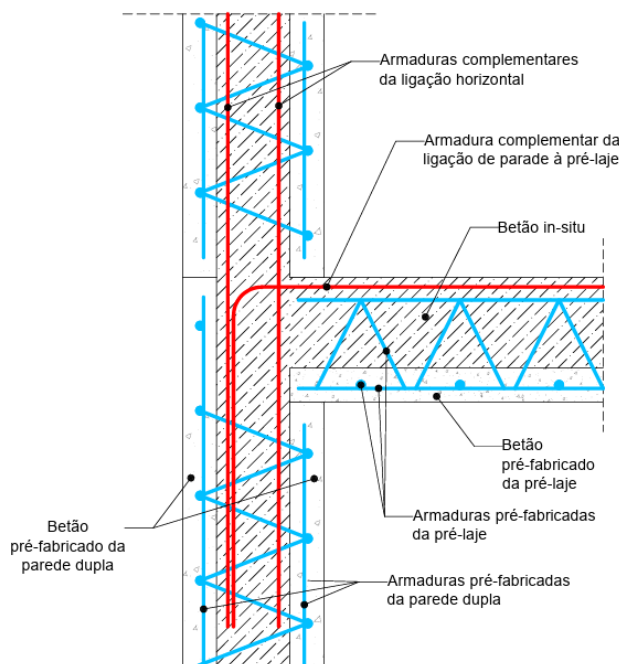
Ligação horizontal da parede dupla e da pré-laje
